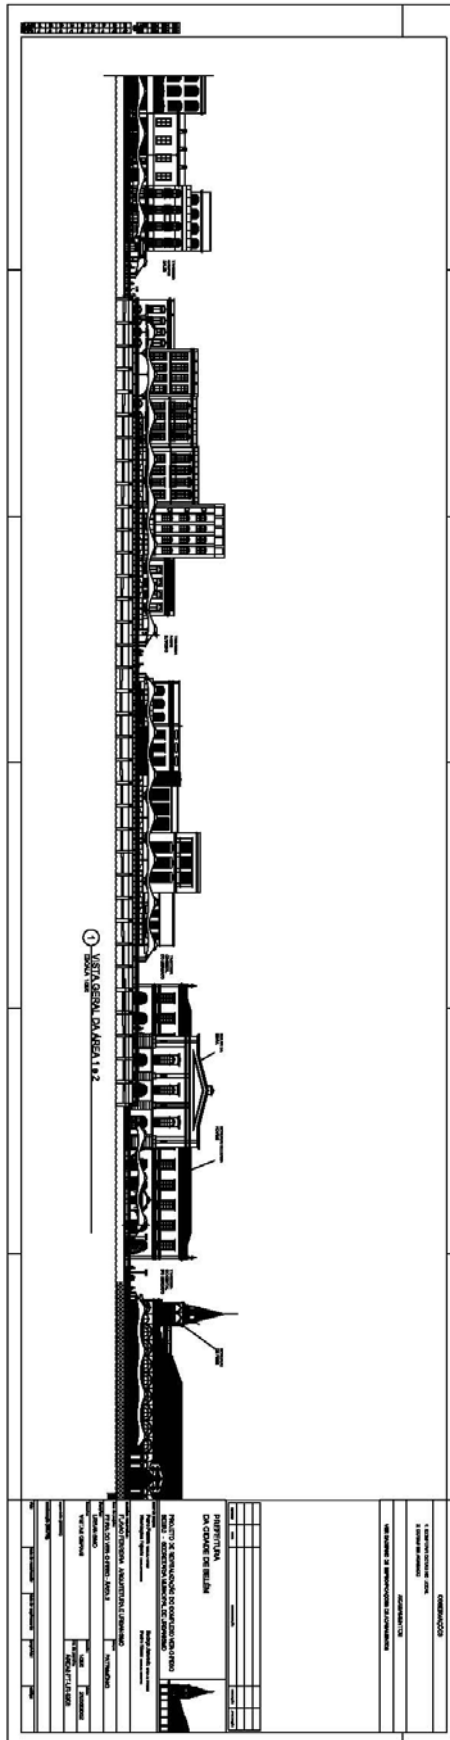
Elevação Geral do Projeto Ver-O-Peso. Fonte: P. M. De Belém.
